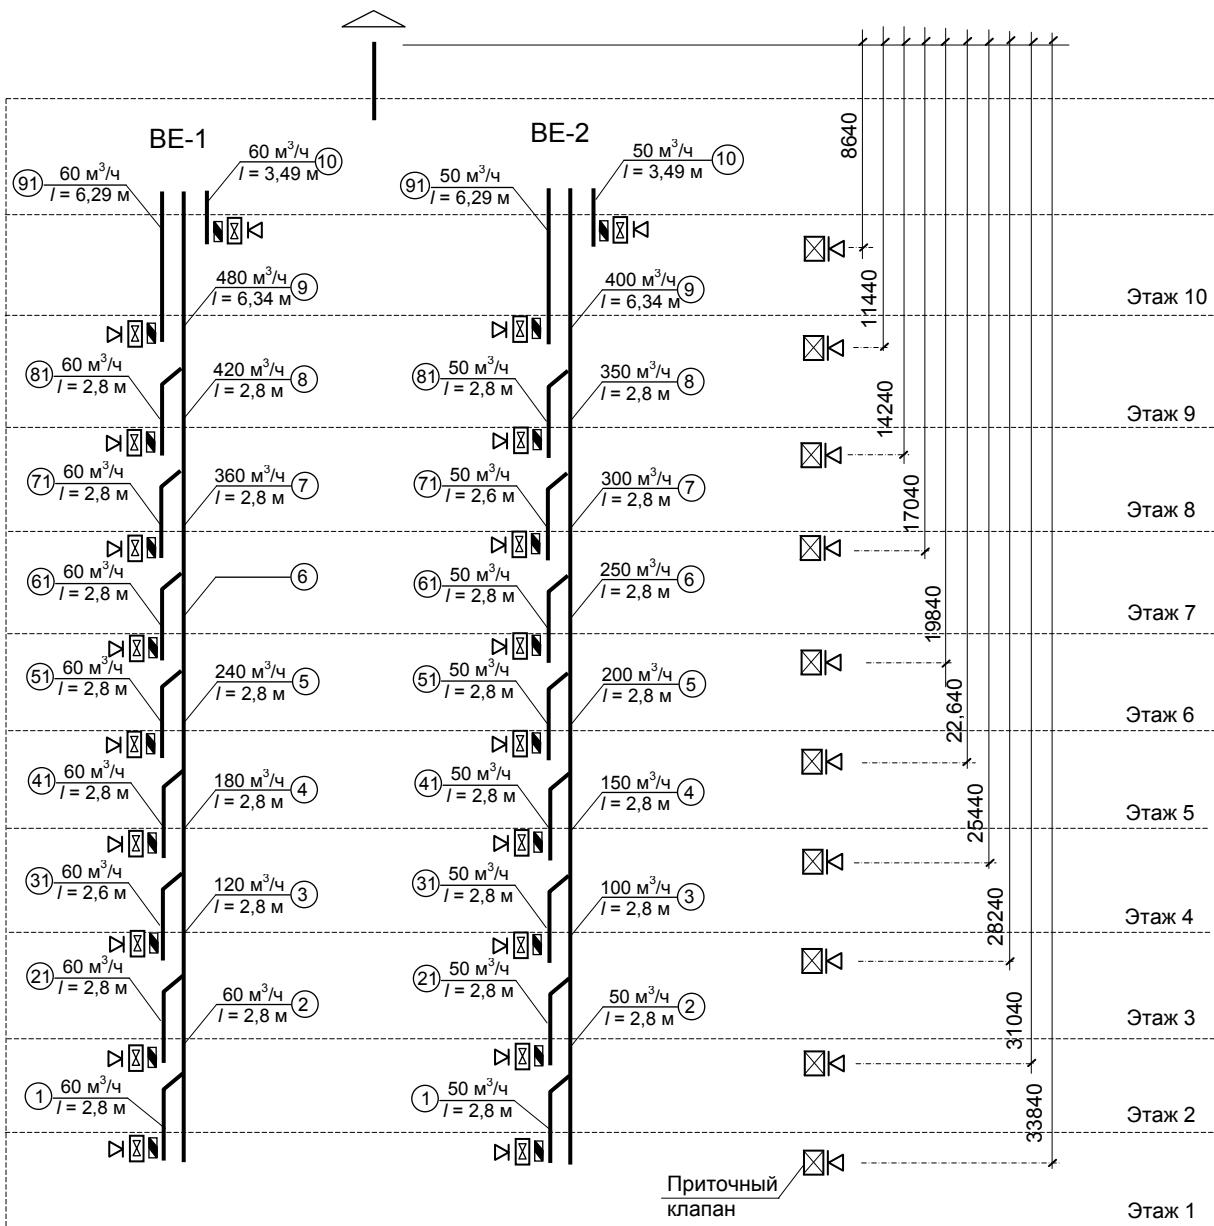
Расчетные схемы систем вентиляции BE-1 и BE-2 рядовой секции
